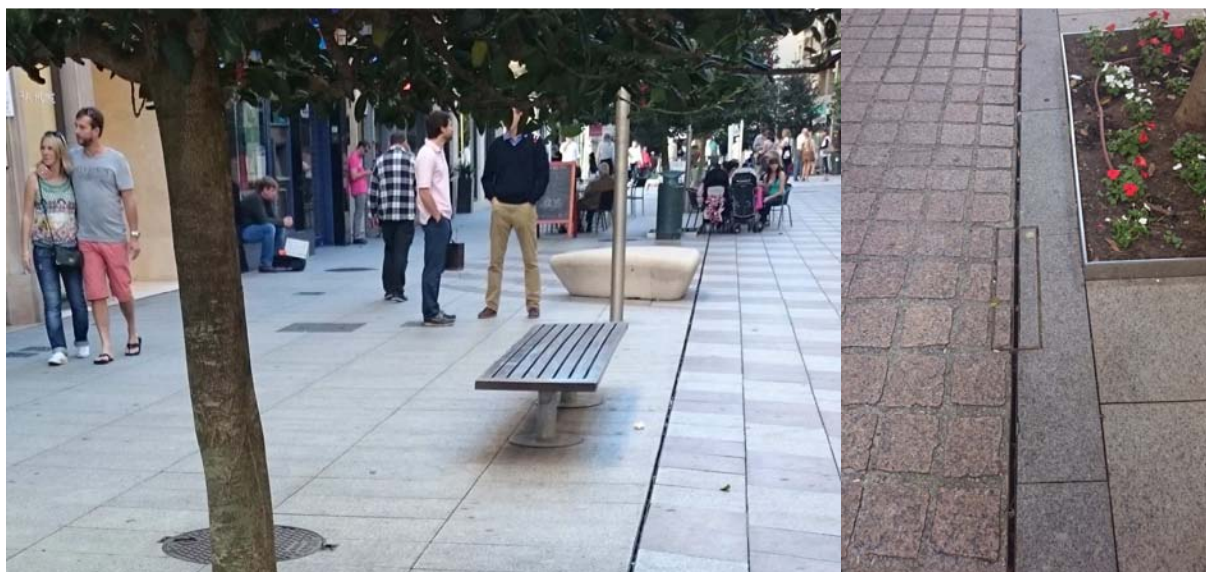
Ejemplos de sistema de drenaje superficial utilizando las juntas en el pavimento. Santander
